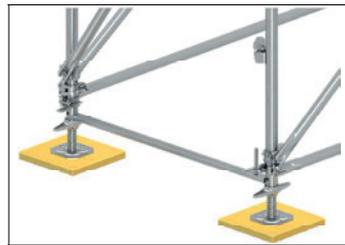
Last verteilernder Unterbau mit Holzbohlen
